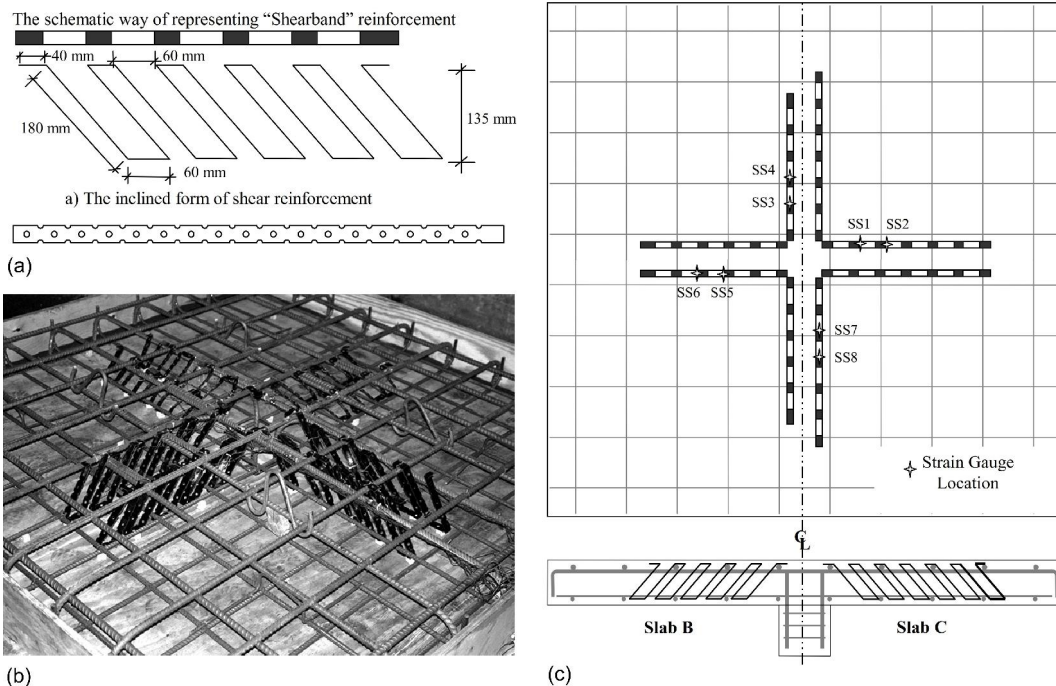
Pormenor das armaduras de punção: (a) Bandas inclinadas; (b) Fotografia da armadura de punção da laje PSS-B; (c) Pormenor das armaduras de punção das lajes PSS-B e PSS-C [54].
